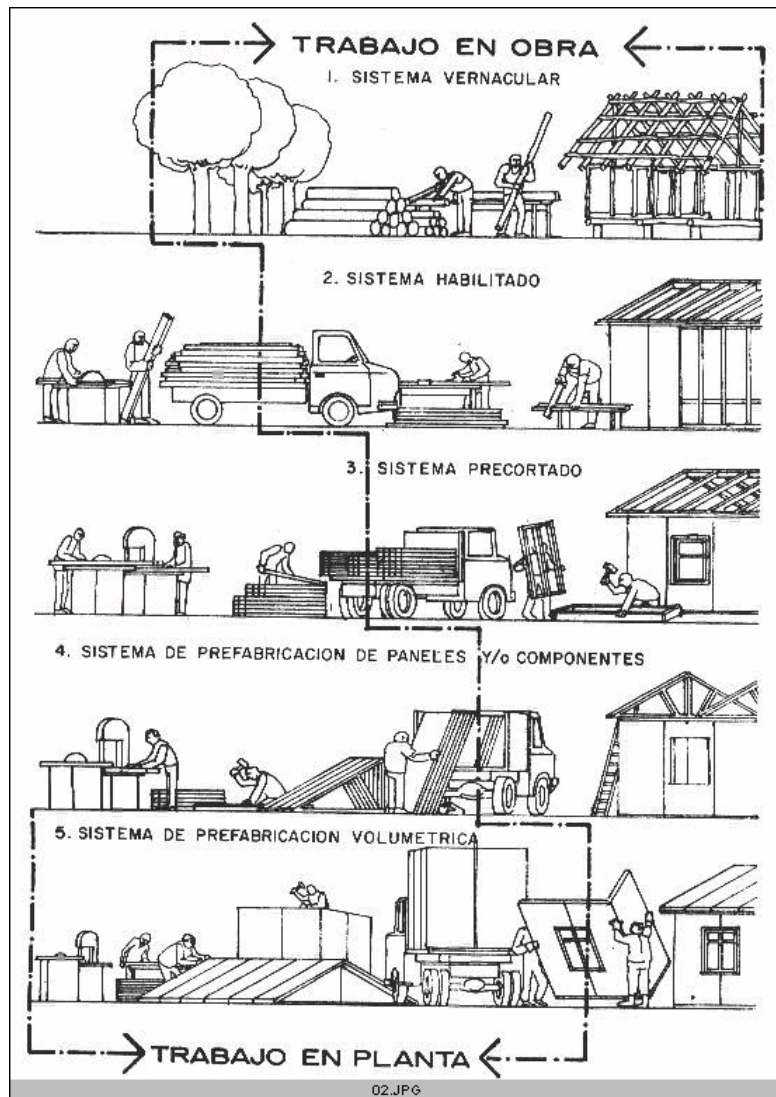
Tipos de sistemas constructivos con madera (tomado de PADT-REFORT, 1984).
